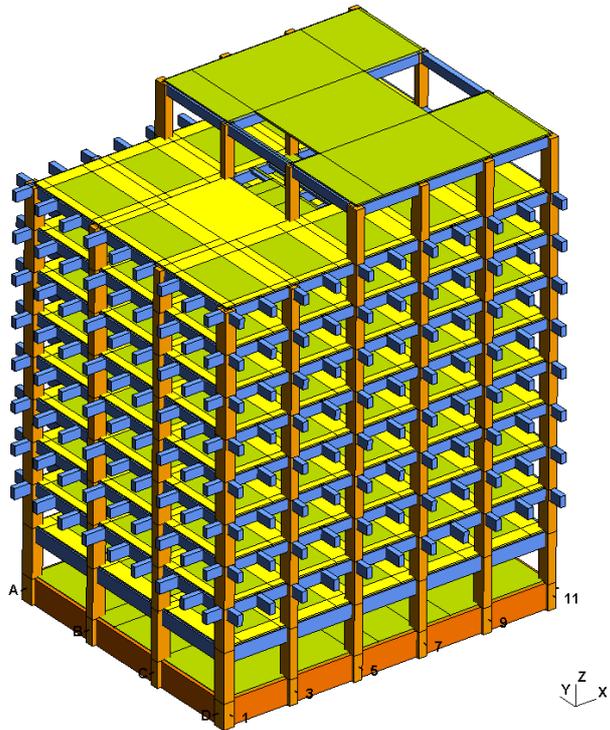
Vue 3D des planchers, poutres et poteaux
